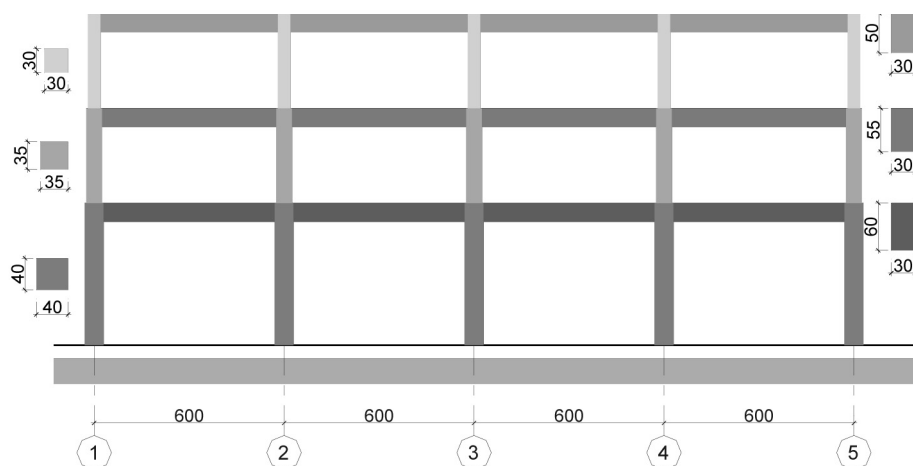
Pórtico típico del edificio porticado con vigas de canto.
